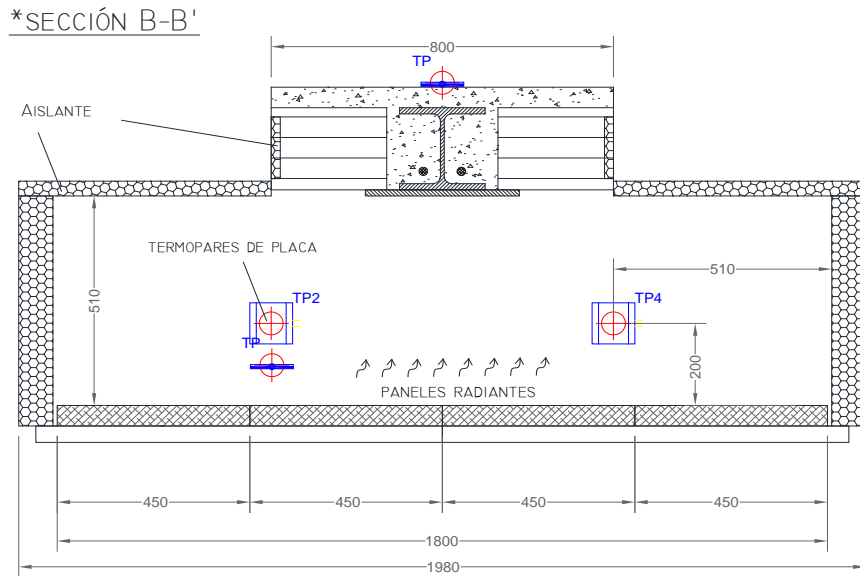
Plano de sección longitudinal del horno durante el ensayo de una viga.
